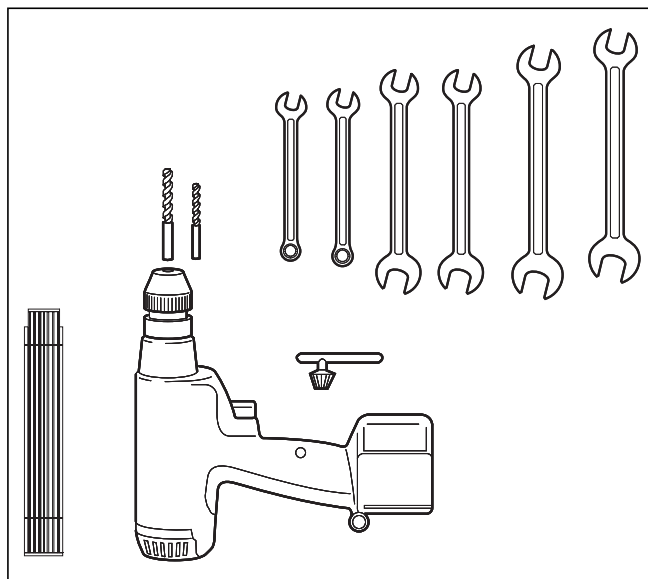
Benötigtes Werkzeug bei Wellplatten-Eindeckung
